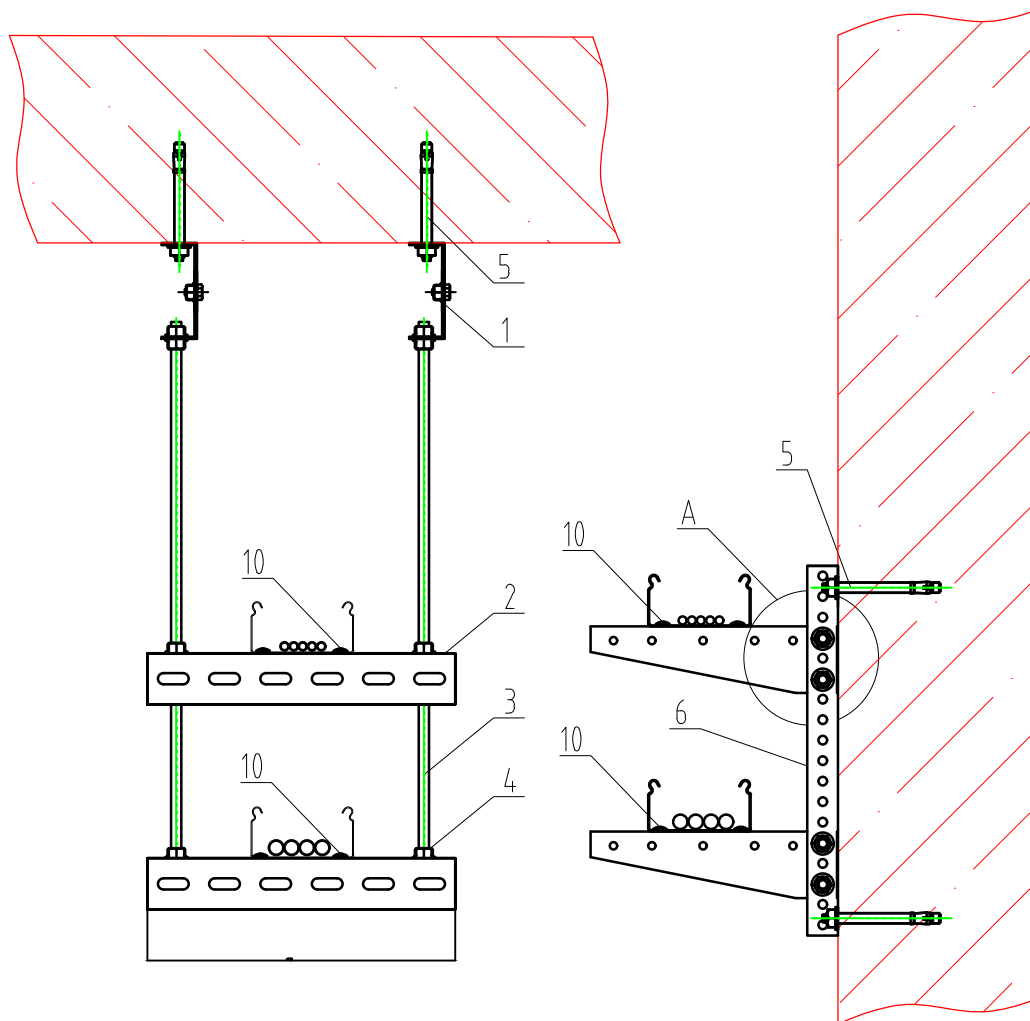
Вариант крепления траверсы на шпильках к бетонному перекрытию
